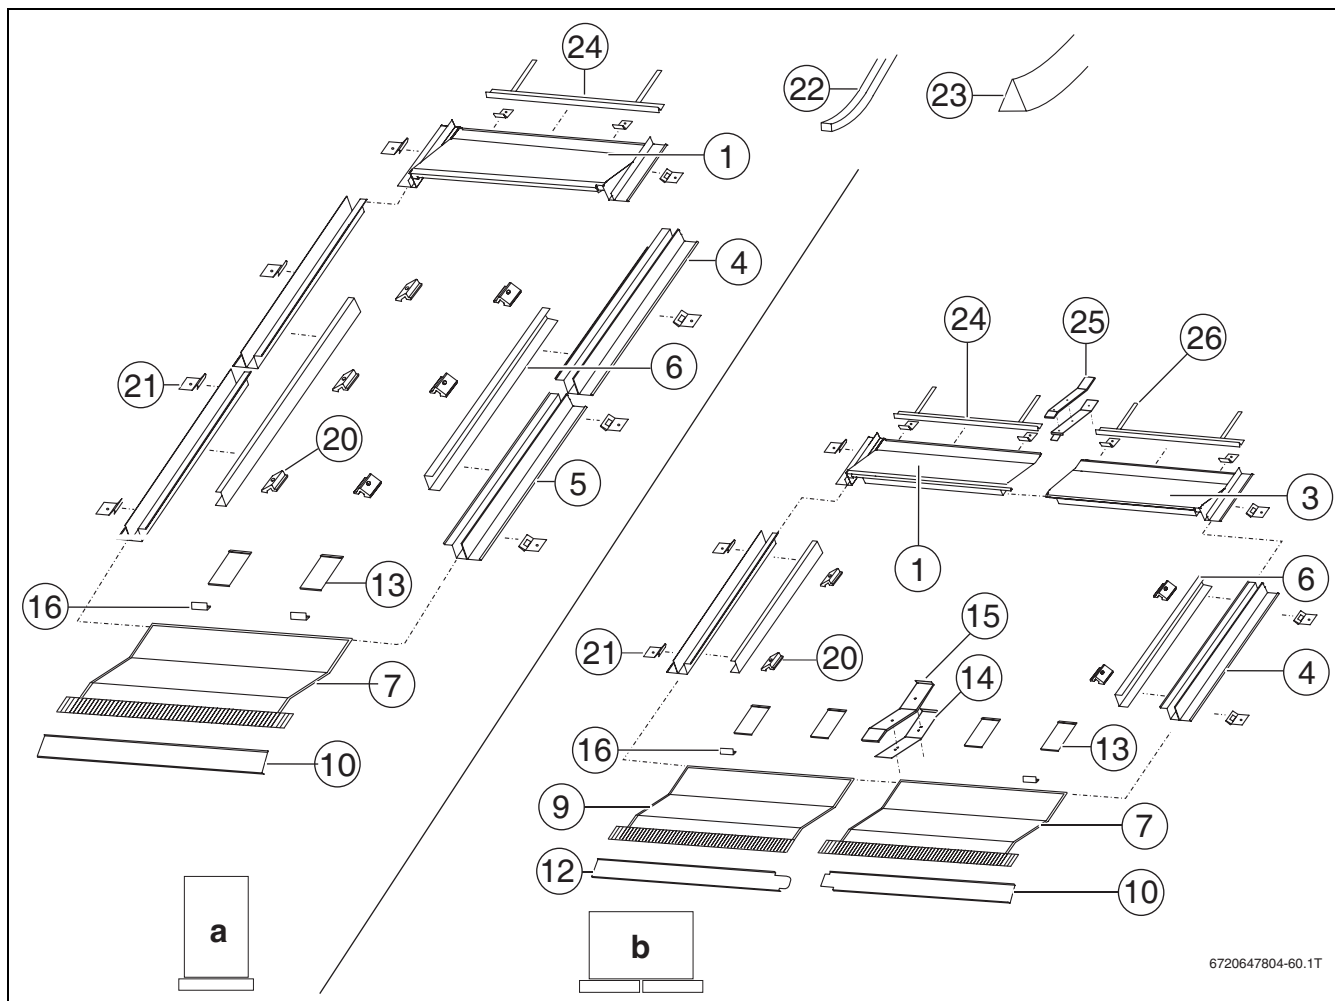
Montage-Set für 1senkrechten bzw. waagerechten Kollektor: 1 Montage-Set Grundaussführung
